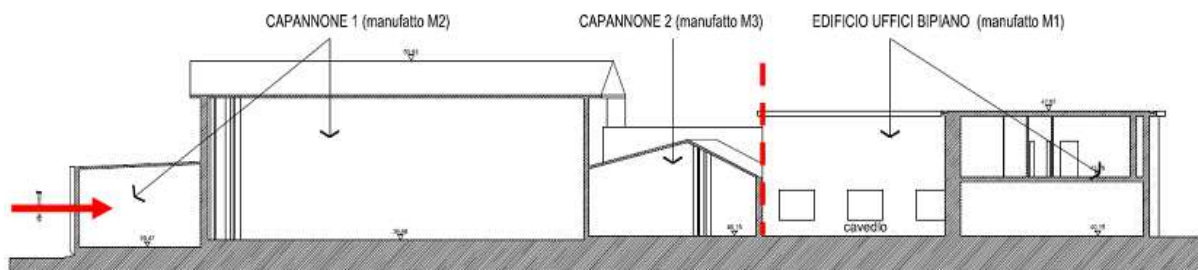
Sezione longitudinale cantiere in fase 1 (edifici M2 e M3)
